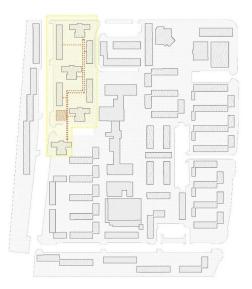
Plano área de intervención B MY CITY - Elaboración propia
